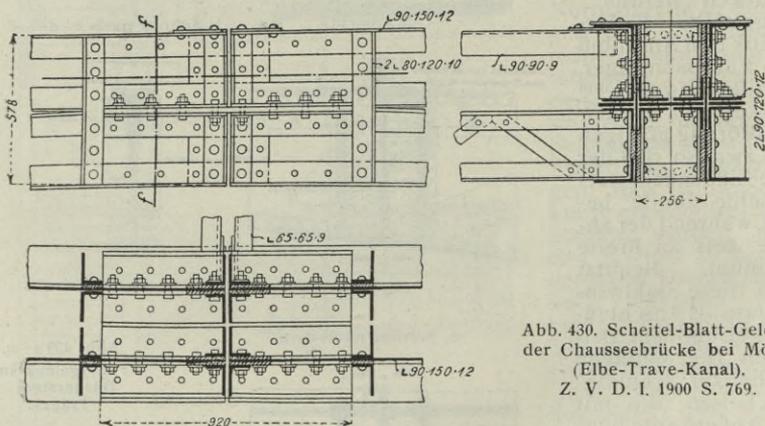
Scheitel-Blatt-Gelenk der Chausseebrücke bei Mölln (Elbe-Trave-Kanal).
